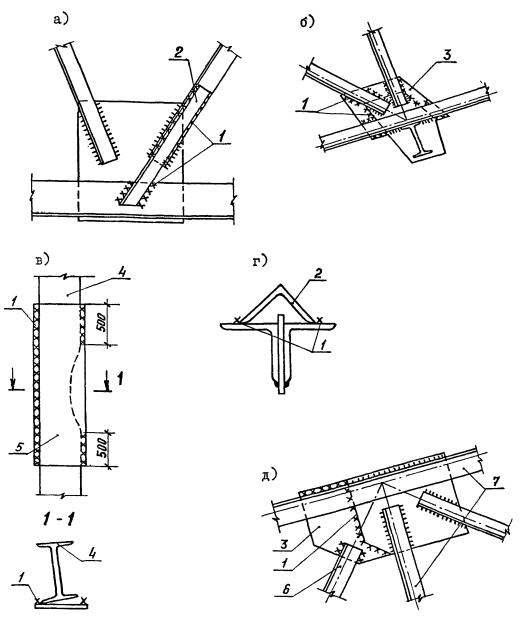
Ремонт стальных конструкций конвейерных галерей а-раскоса при трещинах, коррозии или недостаточной длине сварных швов прикрепления; б -нижнего узла наваркой дополнительной фасонки; в -погнутой ветви опоры; г -раскосов фермы; ее -верхнего пояса фермы; 1 -монтажные сварные швы; 2 -усиливающий уголок 3 -дополнительная фасонка; 4 -ветвь опоры; 5 -усиливающая накладка; 6 -дополнительный стержень усиления фермы; 7 -существующие стержни фермы.
